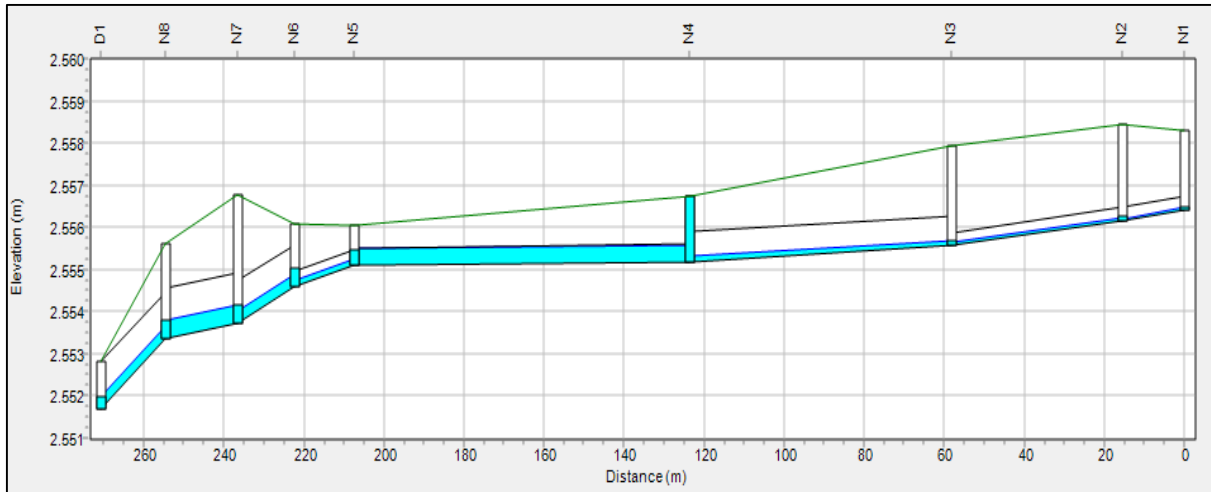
Perfil de alcantarillado pluvial que corresponde al tramo Carrera 9 entre Calles 110 - 112.
